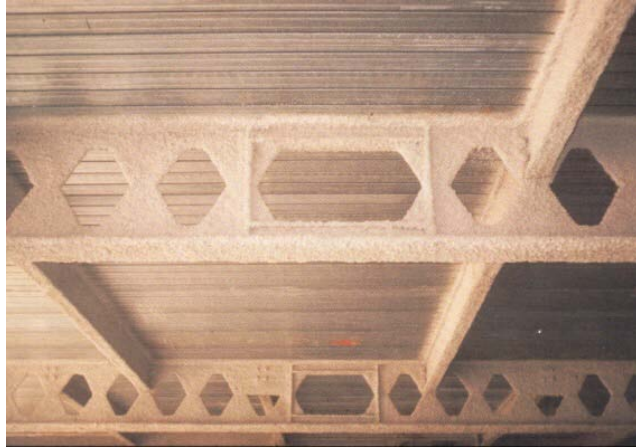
, Viga celular de perfil WF con recubrimiento intumescente
